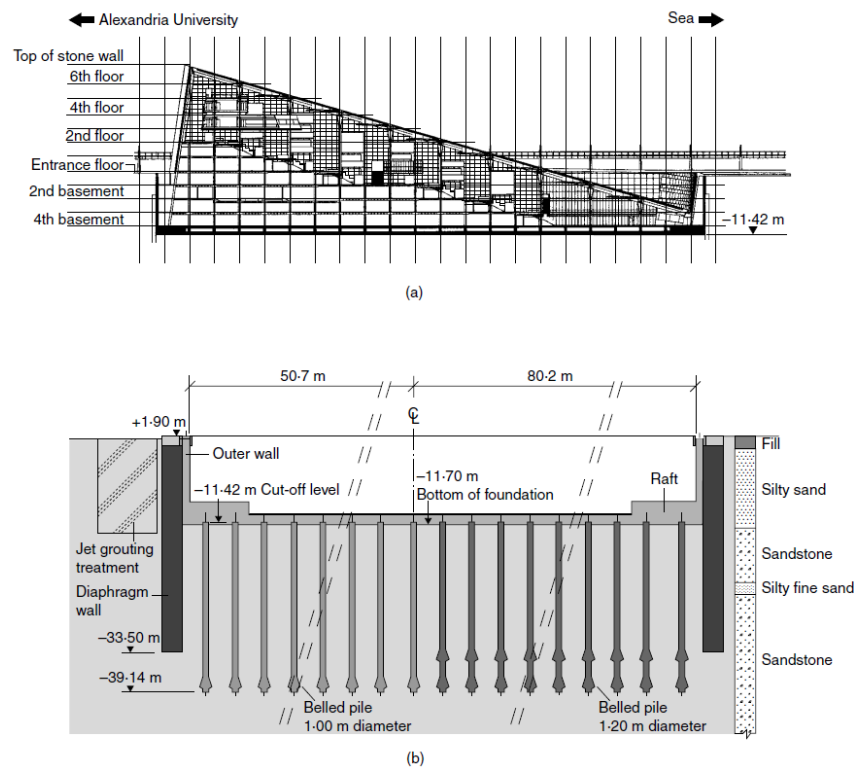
(a) Arquitectónico (b) Fundaciones (M. Hamza & M. Ghoneim, 2000)
